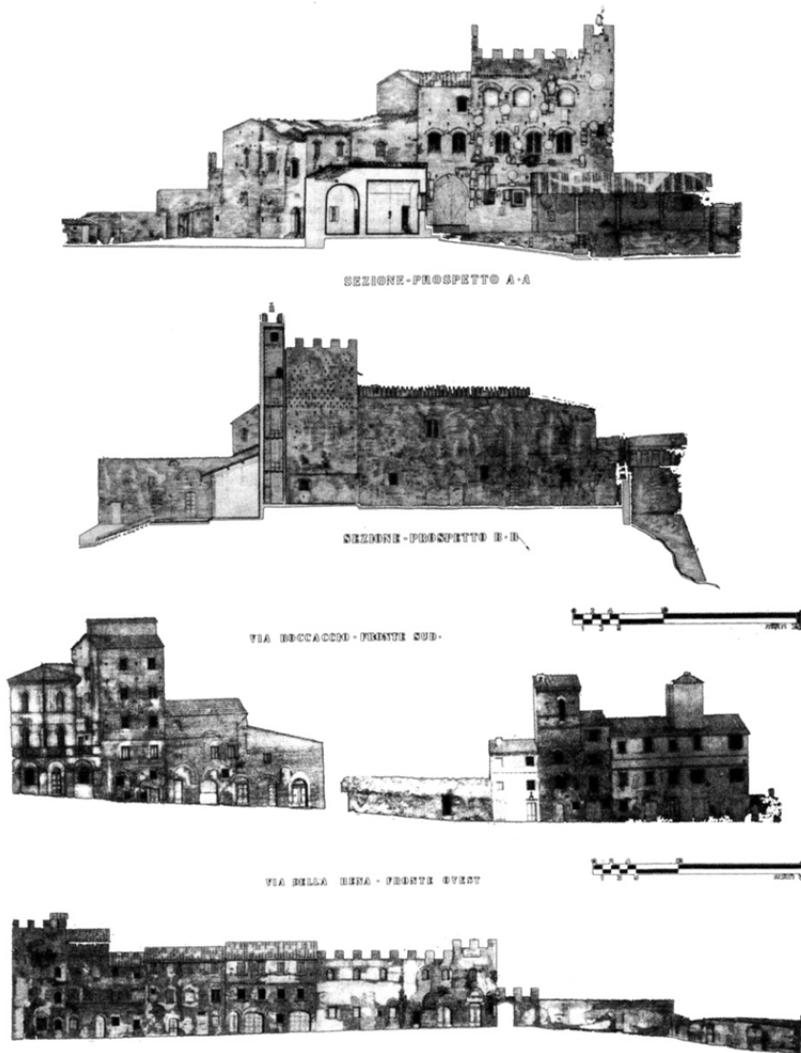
Prospetti e sezioni con raddrizzamenti fotografici
